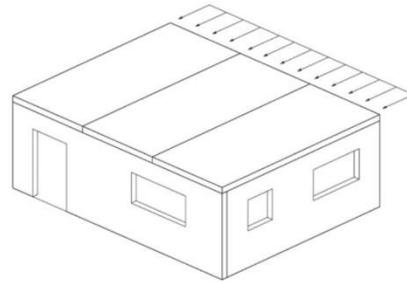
Diaphragme de plancher : Effort de traction induit sur les joints entre panneaux
